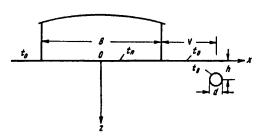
Схема к расчету влияния подземных сетей на тепловой режим основания здания
